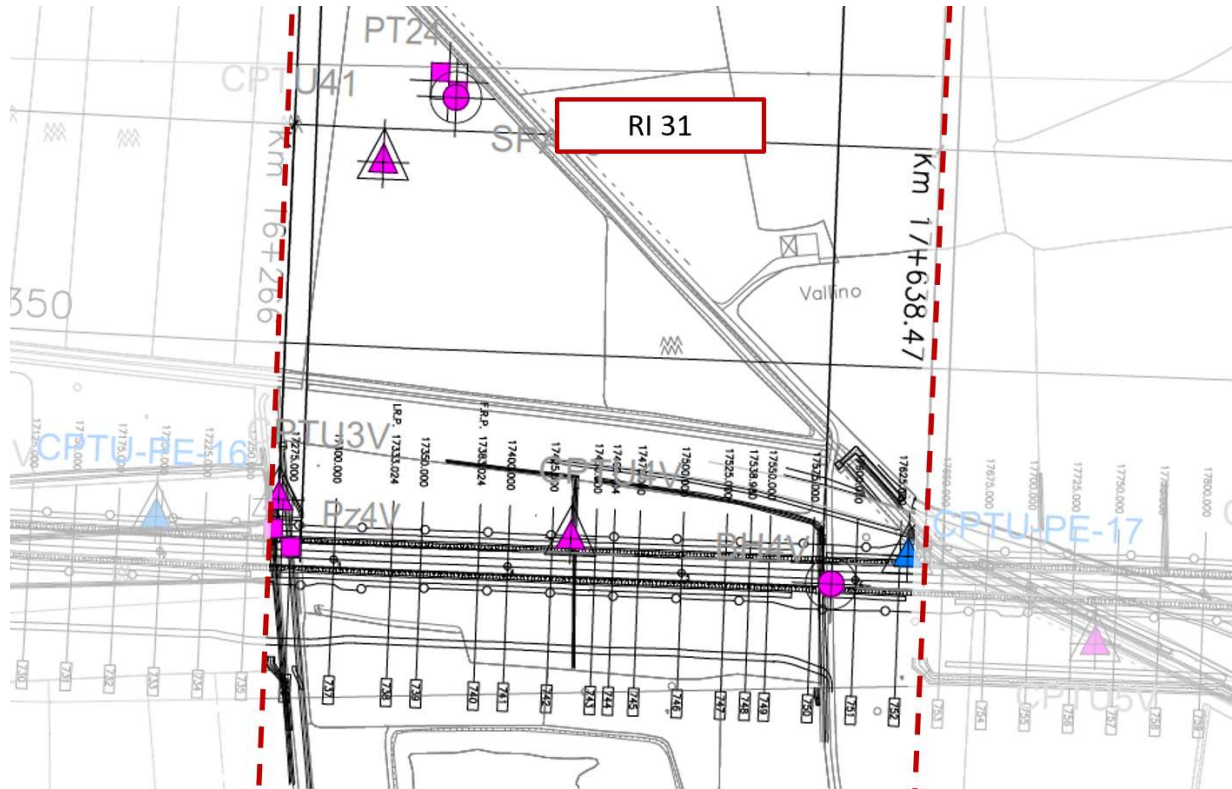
Planimetria Rilevato RI31, estratto dalla Planimetria Generale (Doc. Rif. [3])
